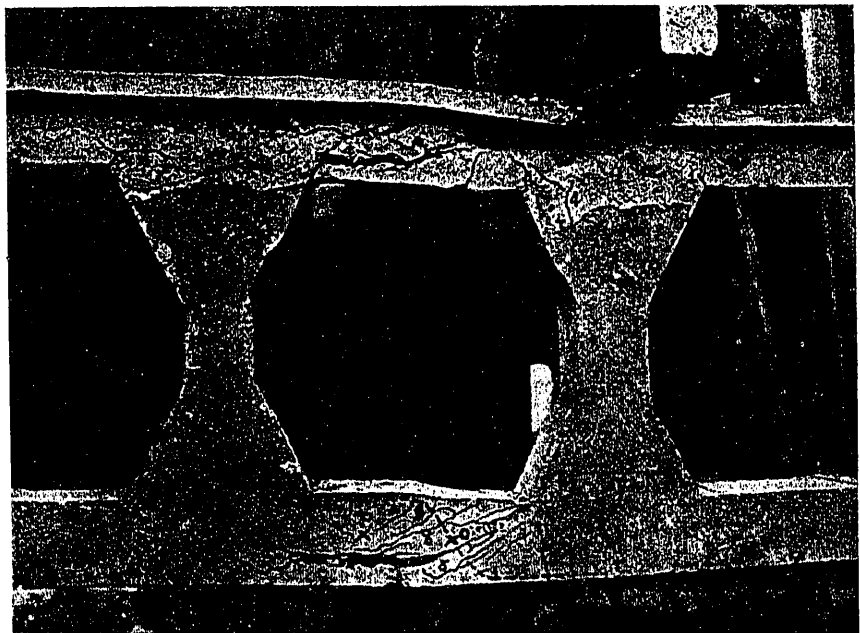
Estructura ensayada hasta rotura durante la construcción de los nuevos almacenes Laffayette
